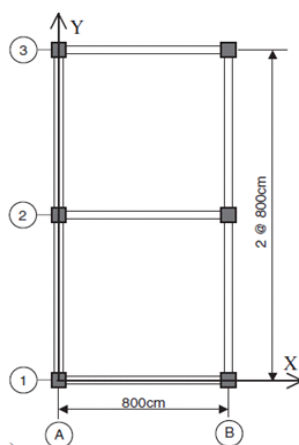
Struttura di riferimento (Pianta) (Almazan et al. 2003)
